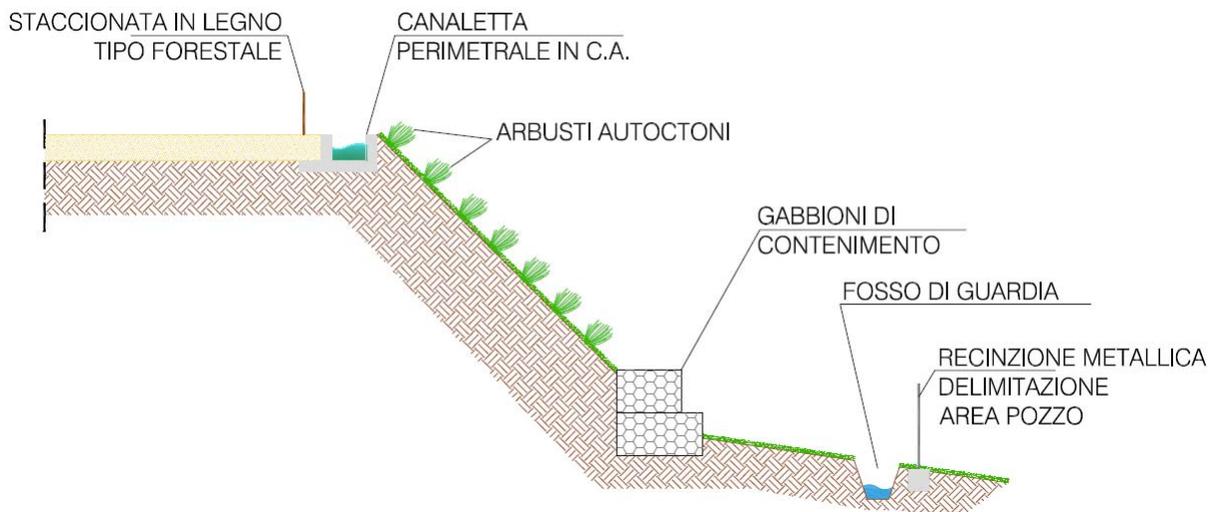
f Sezione sistemazione a verde delle scarpate
